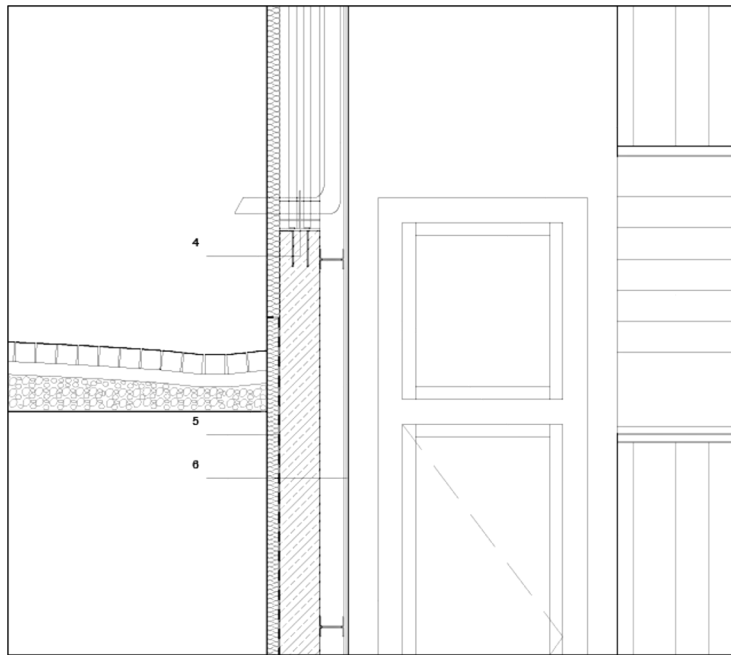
; Pormenor P2 da figura 4.23. 4 – Ligação com um perfil metálico, 10mm; 5 – Tela de impermeabilização, 5mm; 6 – Parede falsa, duas placas de gesso cartonado, 30mm.
